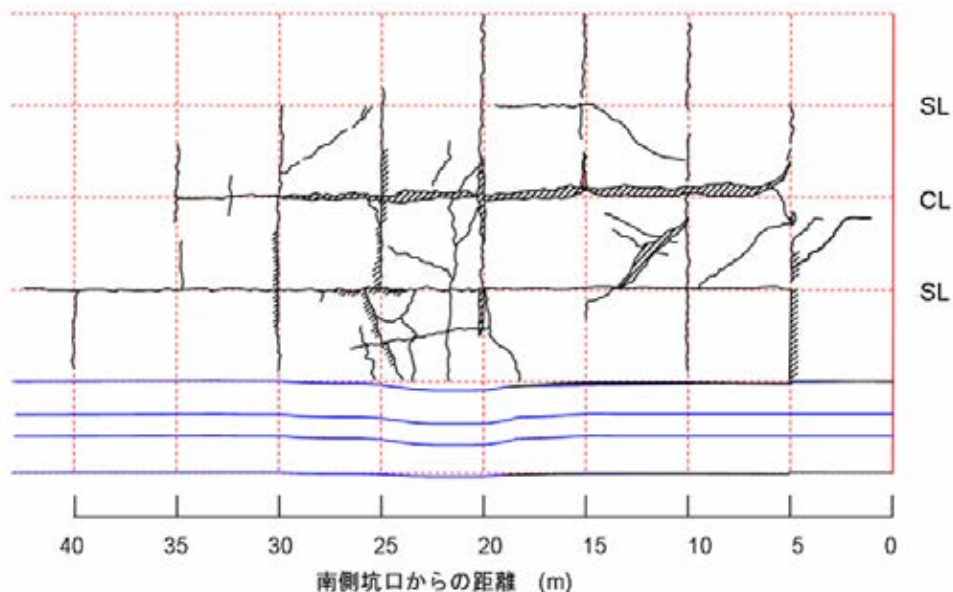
JR 榎トンネル南坑口の内面コンクリート亀裂・変状展開図
